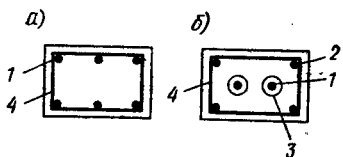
Армирование центрально-растянутых предварительно напряженных стержневых элементов
